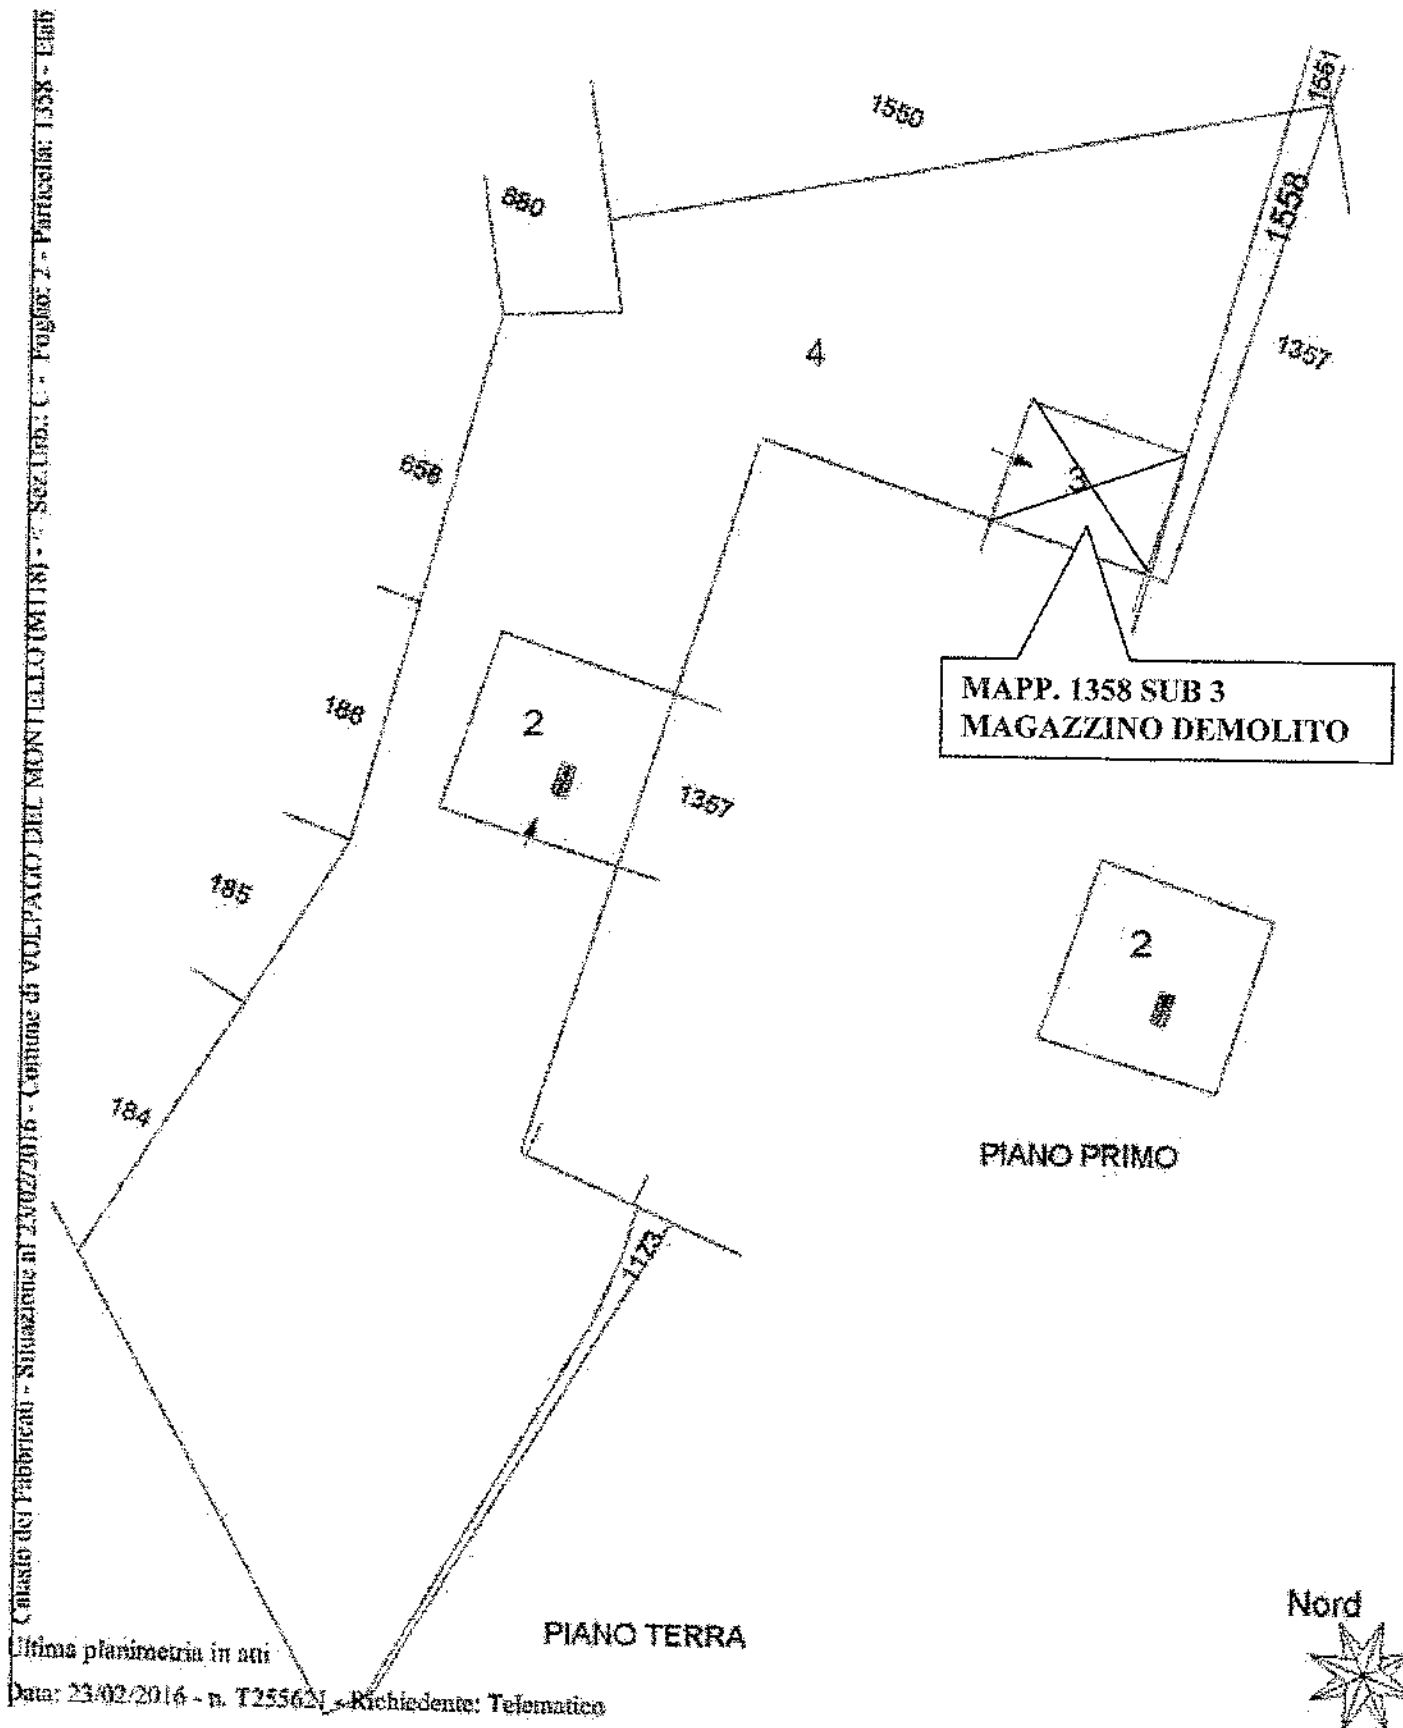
PLANIMETRIA CATASTALE (fuori scala)
